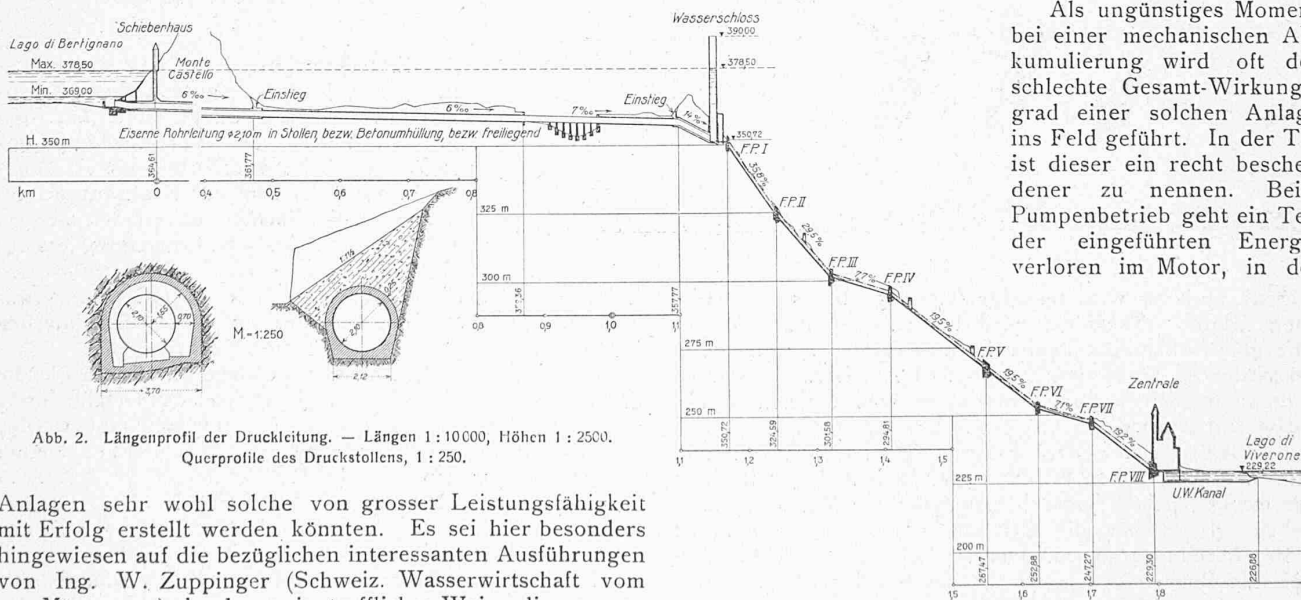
Längenprofil der Druckleitung. — Längen 1:10000, Höhen 1:2500. Querprofile des Druckstollens, 1:250.
